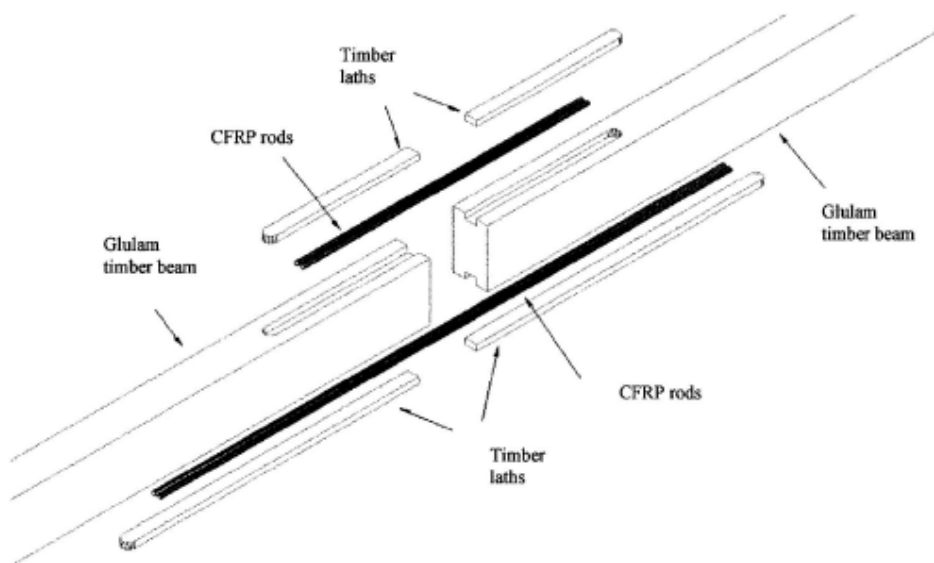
Empalme de dos vigas laminadas con barras de CFRP.³⁶⁶
